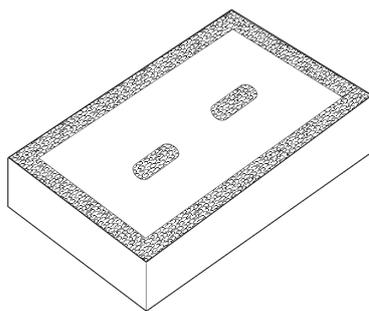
Некачественно установленное дополнительное утепление: на поверхности не использован клей и внешний воздух попадает на стену или на слой между стеной и утеплителем.
